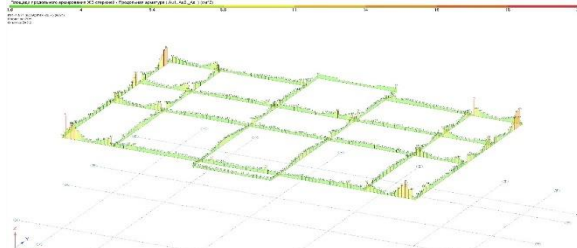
Расположение ригелей и максимальная площадь армирование на нижней грани ригелей с первого по пятые этажи пятиэтажного каркасного железобетонного здания с внутренними и наружными каркасно-обшивными стенами.
